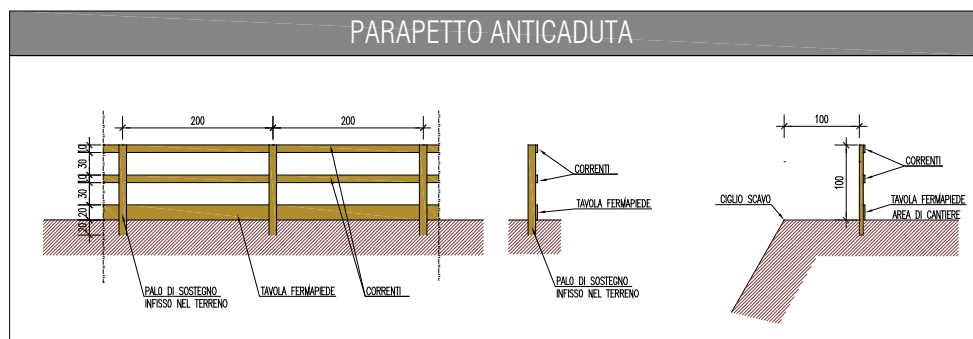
protezione contro la caduta dall'alto – scavi e movimenti terra
